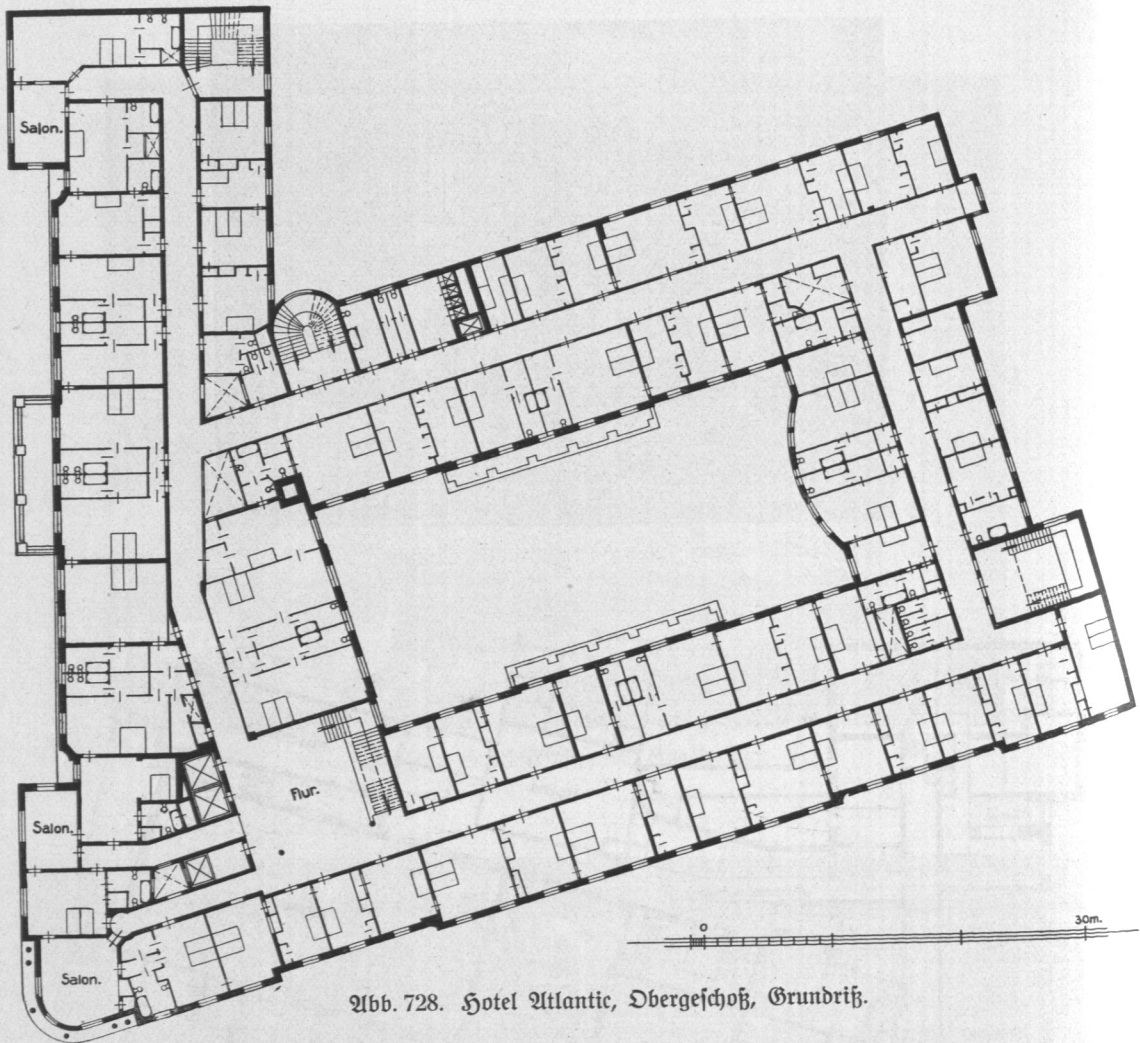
Hotel Atlantic, Obergeschoß, Grundriß.
